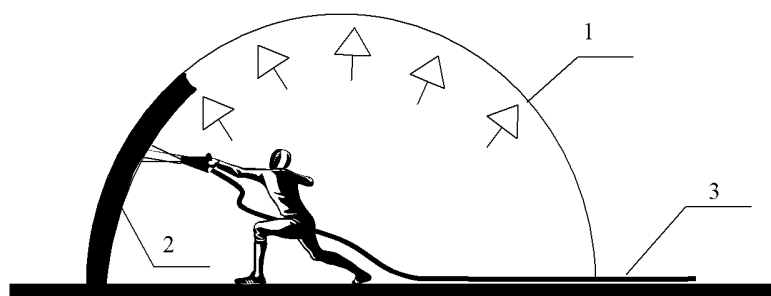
Схема изготовления оболочек набрызгом бетона на внутреннюю поверхность мягкой опалубки: 1- мягкая опалубка, 2 – нанесённая бетонная смесь, 3 – материалы шланги
